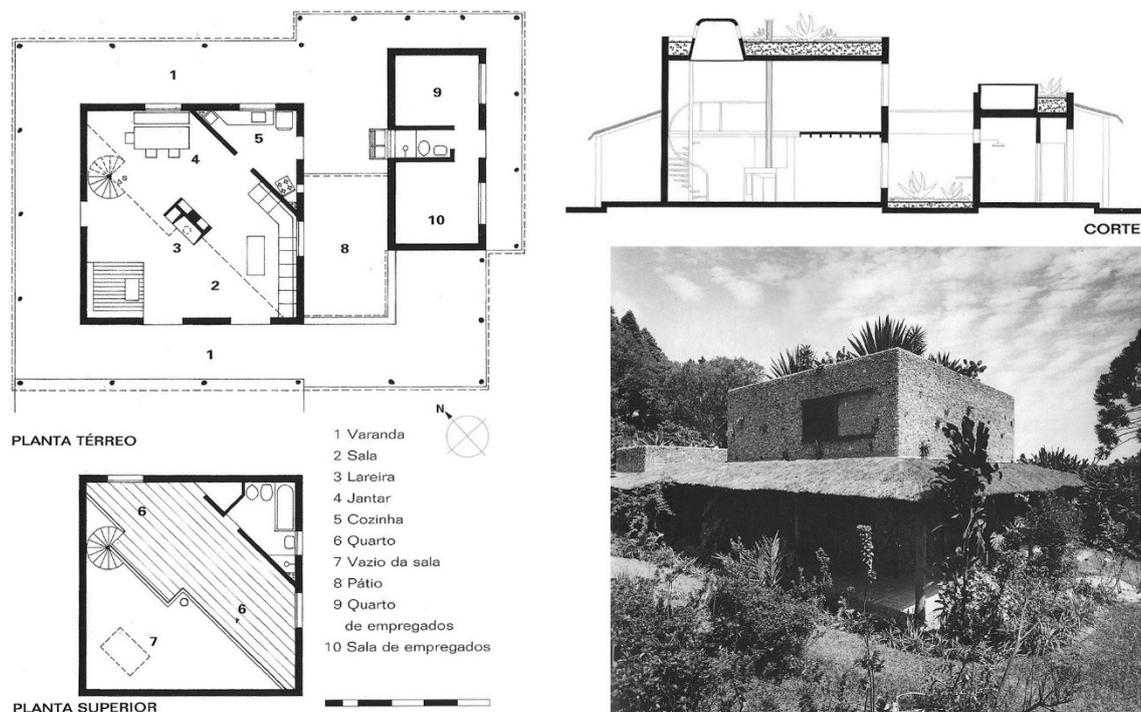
Casa Valéria Cirell, São Paulo. Lina Bo Bardi, 1958. Plantas, corte e vista em 1958.
